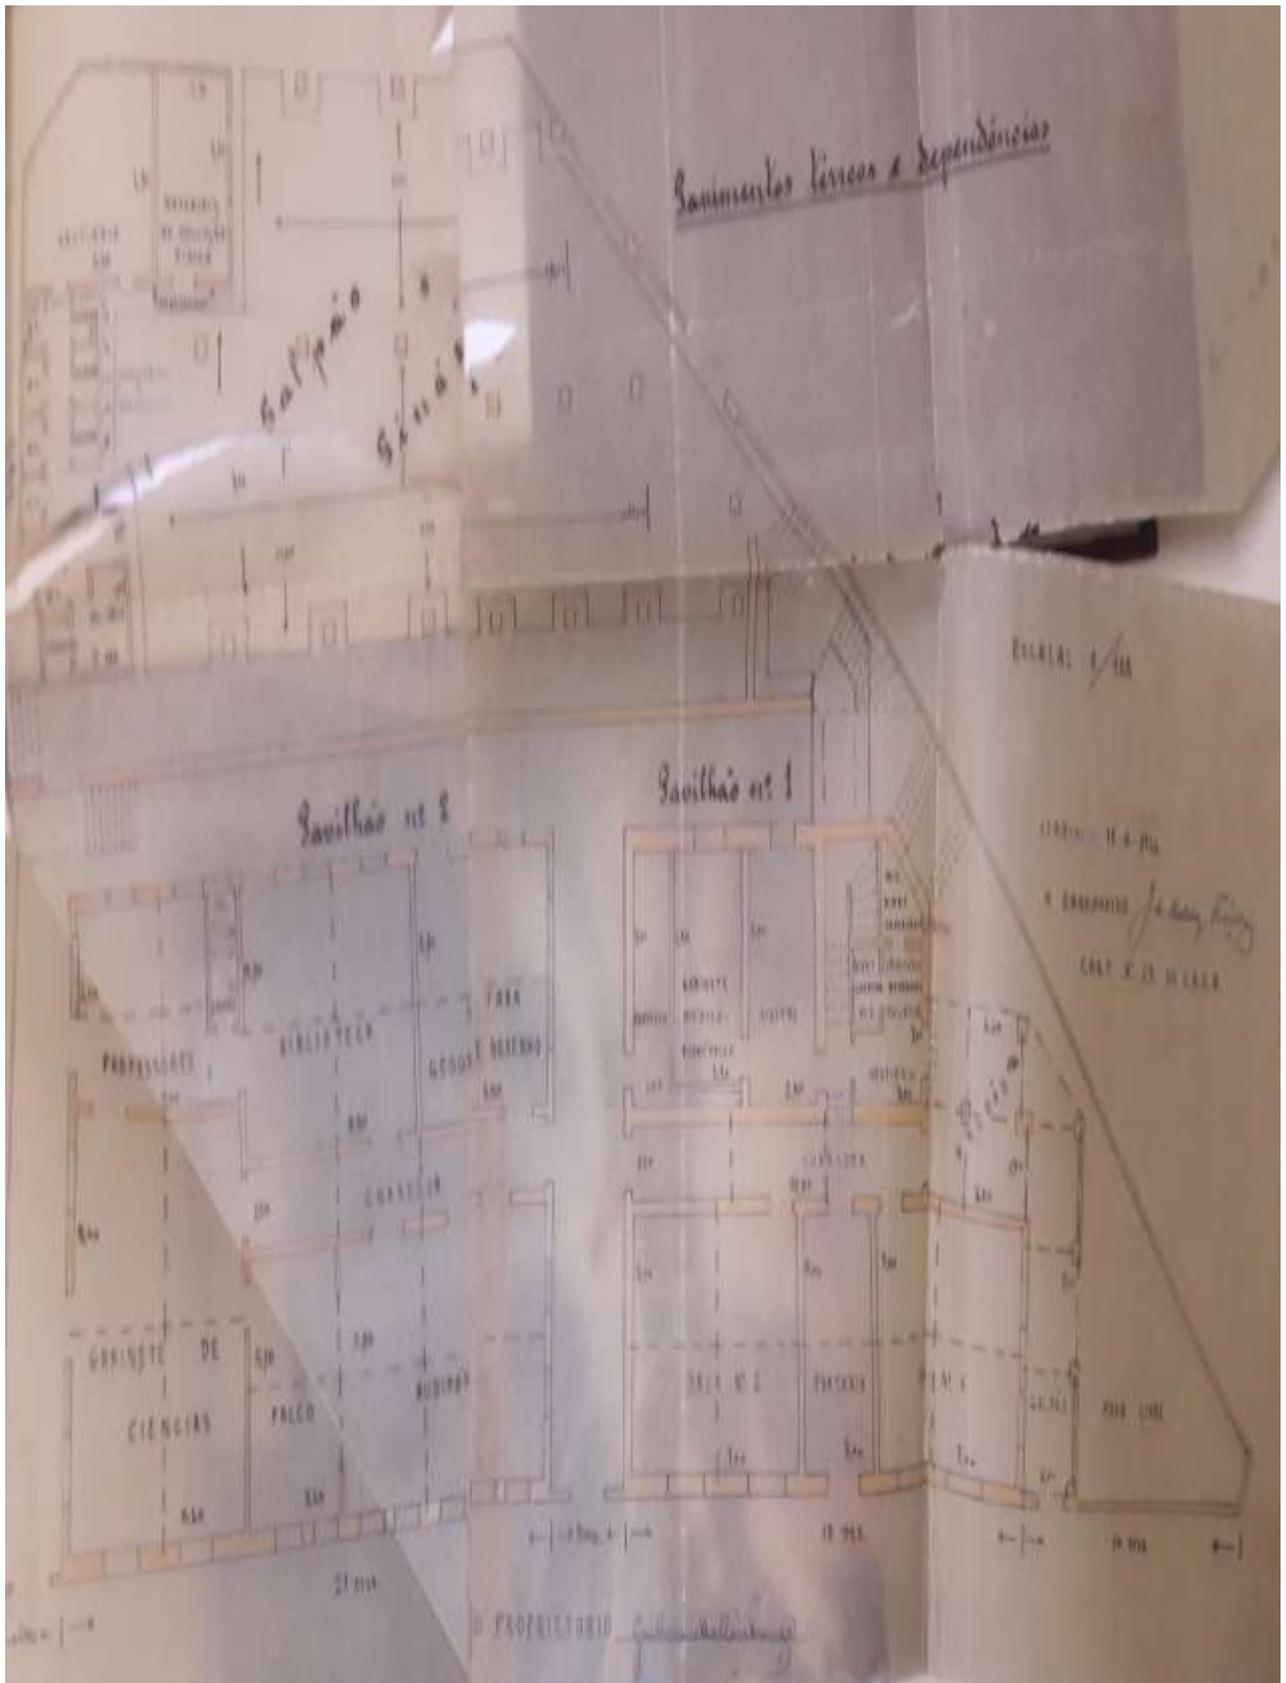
Planta baixa do primeiro pavilhão do Ginásio Monsenhor Messias.
